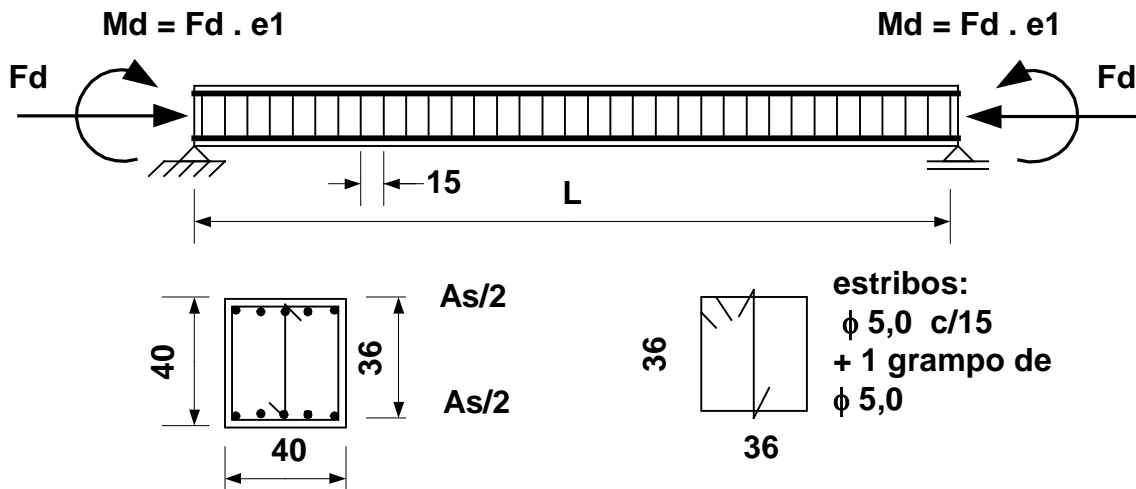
Geometria e carregamento dos pilares de P1 a P27
